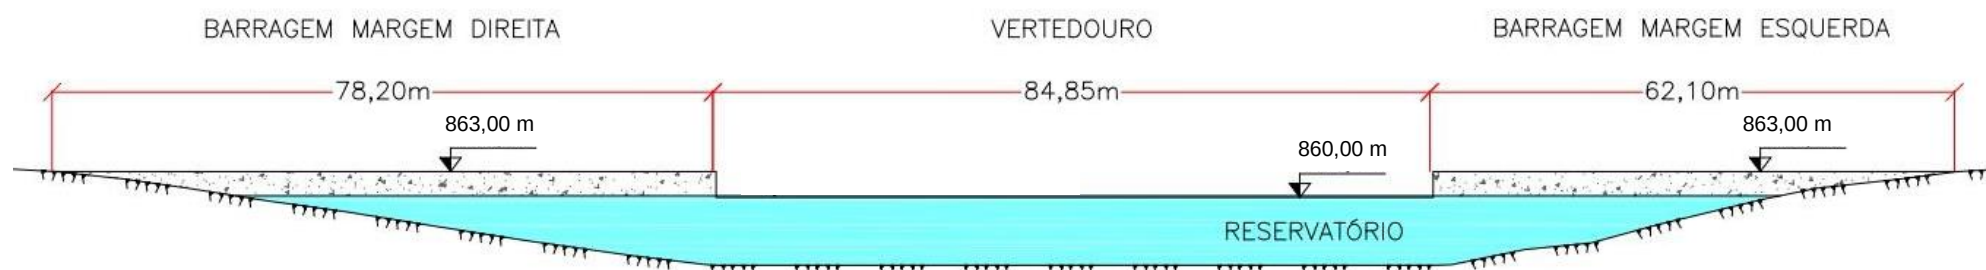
Vista a Jusante do Barramento e Vertedouro da CGH Caveiras.
